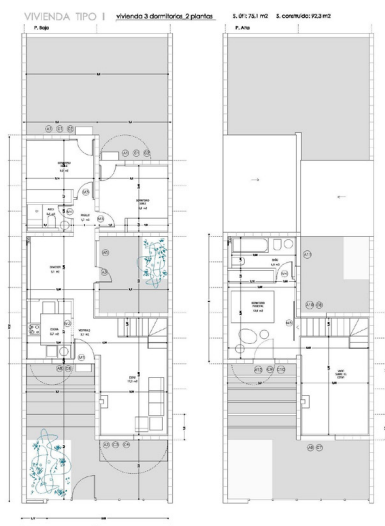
Ramón Araujo. Viviendas en Villarrubio. Planta y vistas de uno de los cuatro tipos de vivienda
